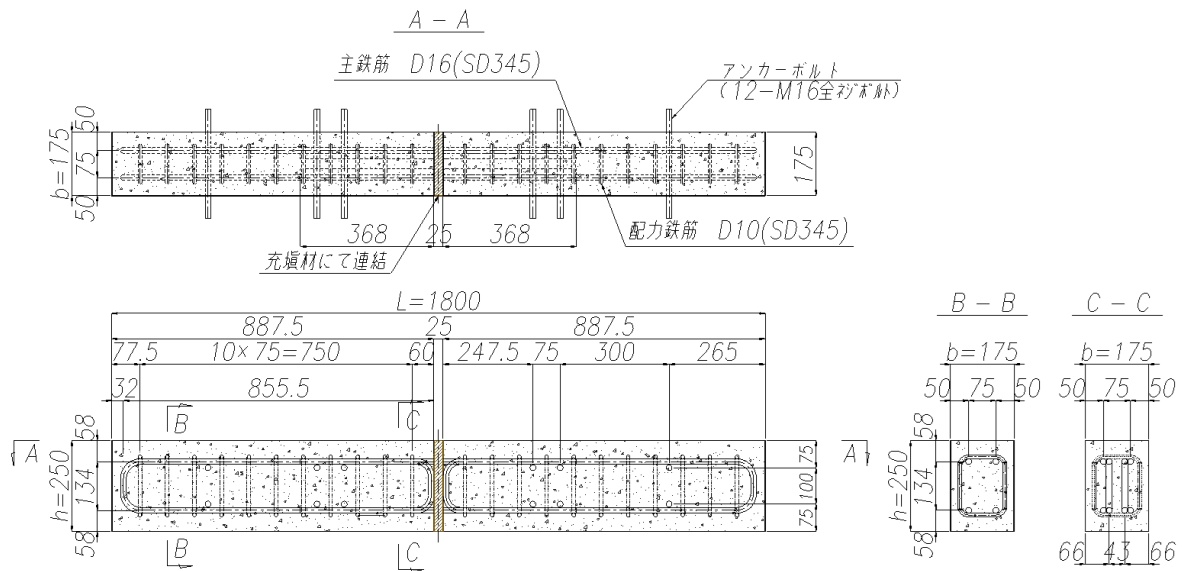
試験体寸法 (No. 3・No. 4 試験体)
